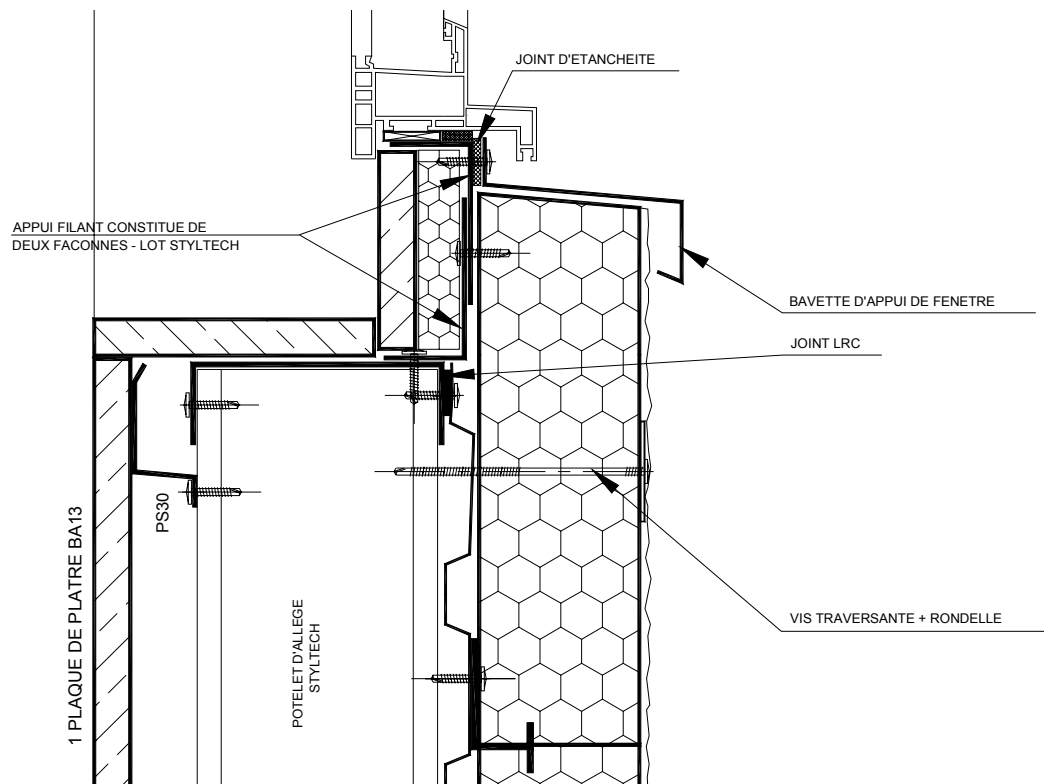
Coupe verticale sur fenêtre – Traverse basse – Menuiserie demi-mur
